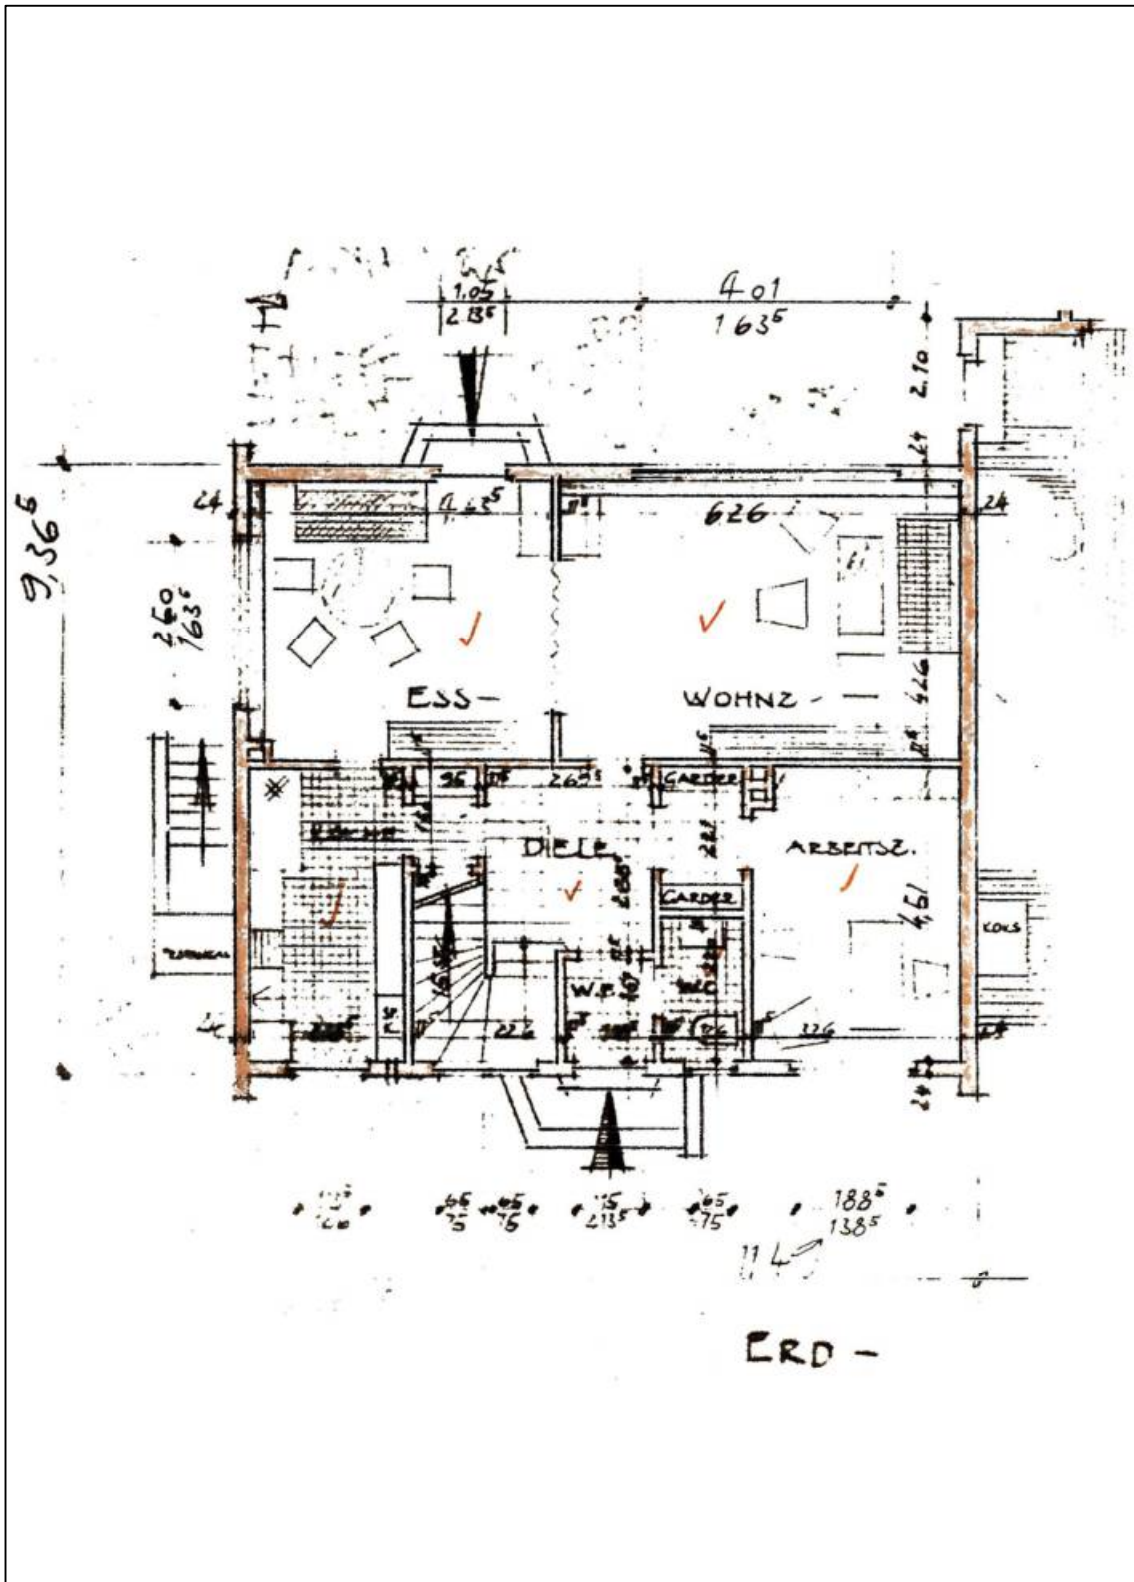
Grundriss vom Erdgeschoss
